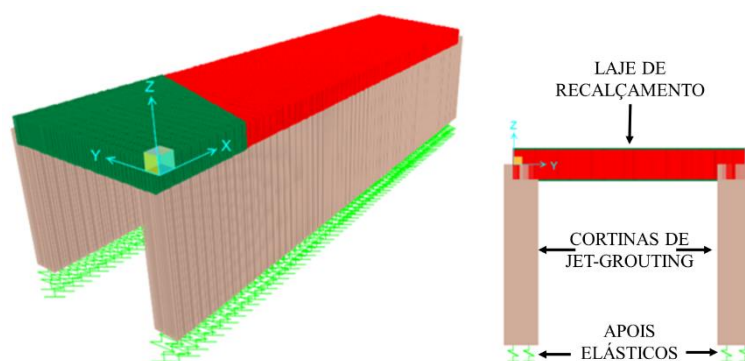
Modelo de análise SAP2000 para a laje de fundação.
